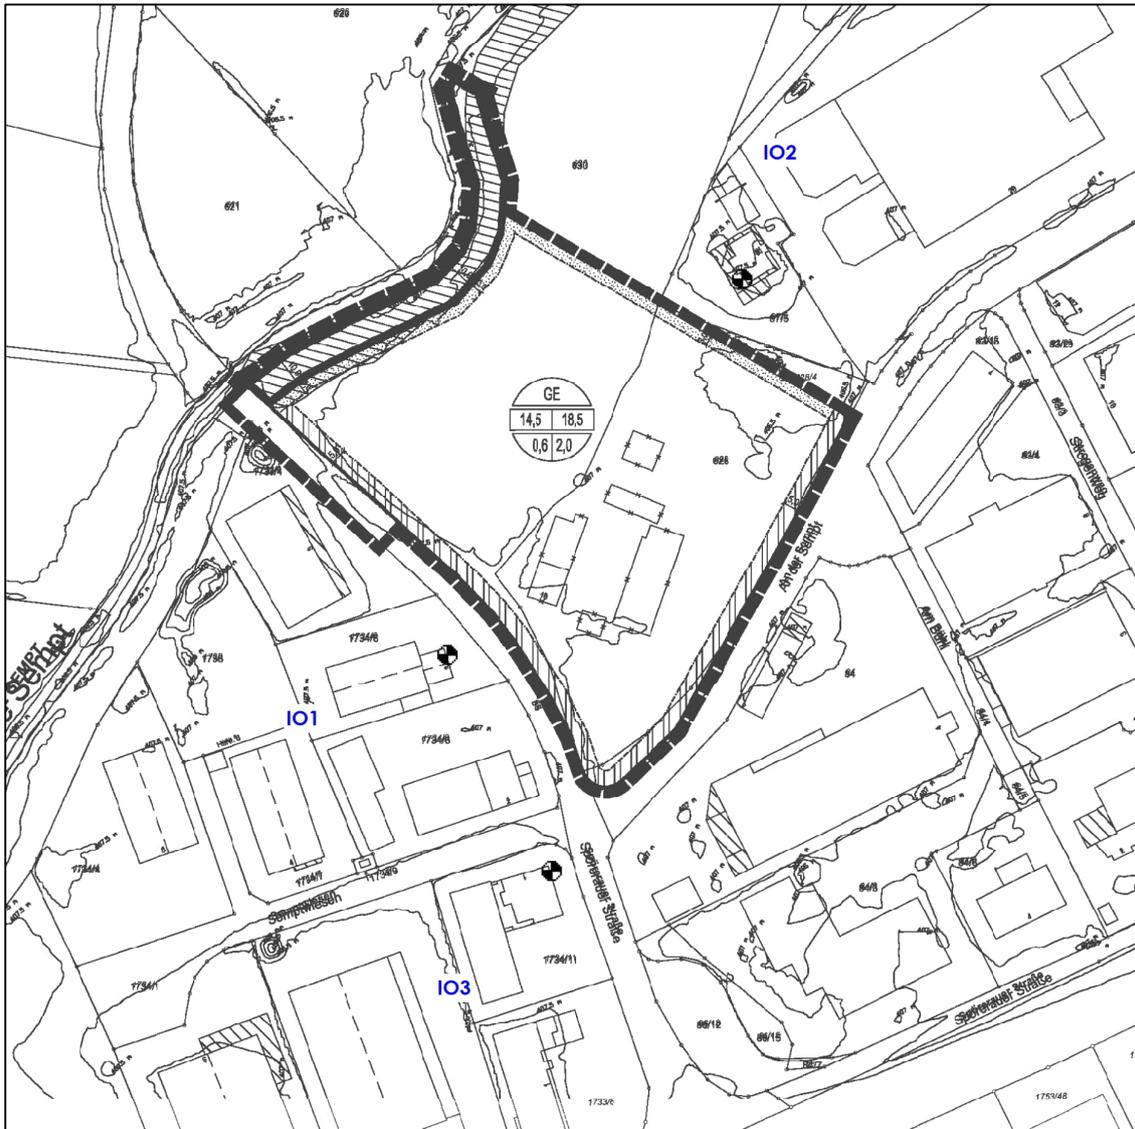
Lageplan mit Darstellung der maßgeblichen Immissionsorte für die Geräuschkontingentierung
